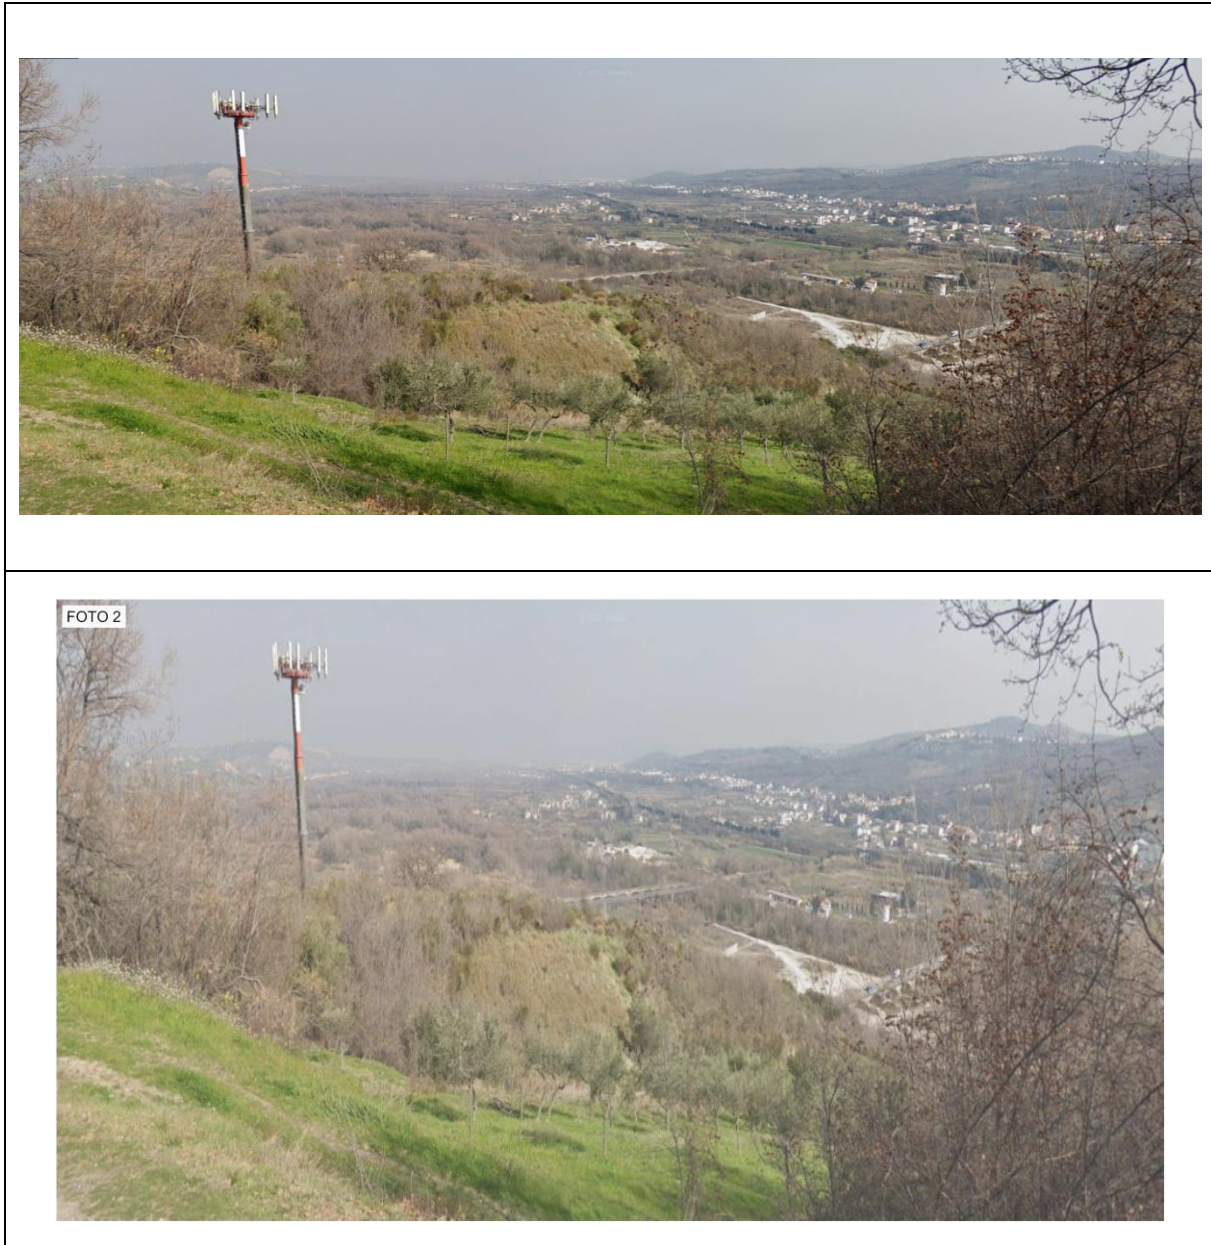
Rendering dell’attraversamento sul Fiume Sangro (stralcio 2) – visuale 2 (collina sul lato ovest): stato attuale (sopra) e progetto (sotto)
